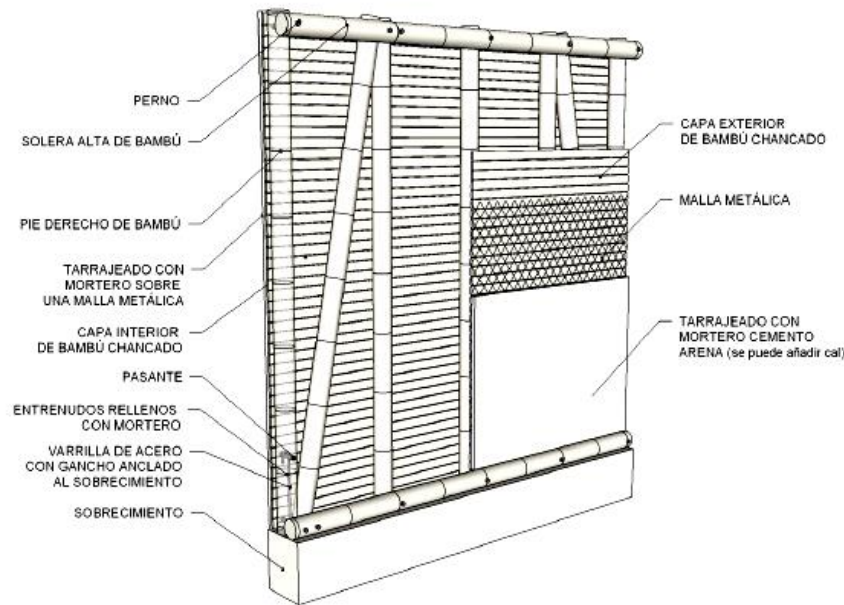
Muro estructural de guadua (Ministerio de Vivienda, Perú, 2011, E.100, BAMBÚ)
